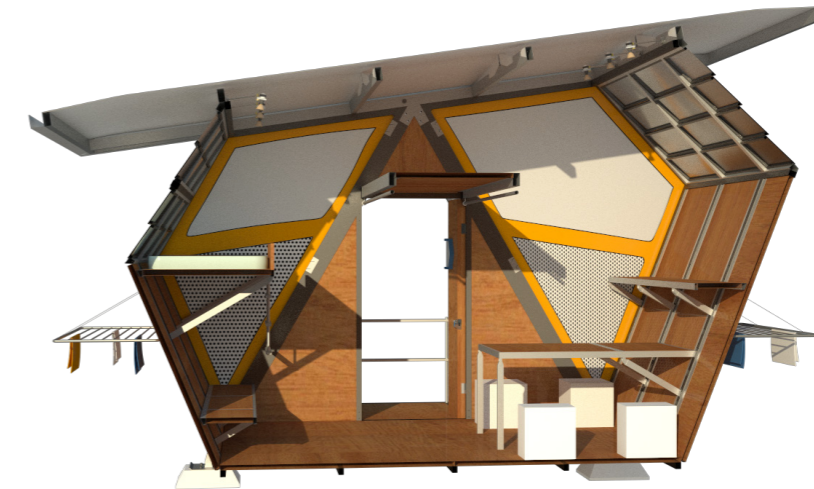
Corte espacial del MAD-Albergue con espacio para comer, sentarse y dormir. Autoría propia.
